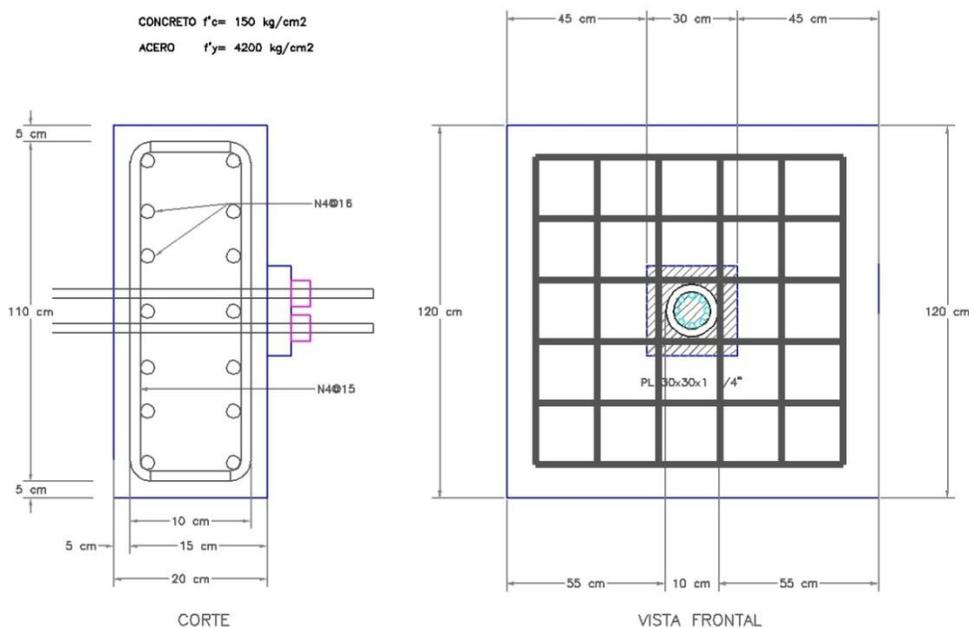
DETALLE DEL DADO DE REACCIÓN O ZAPATA
